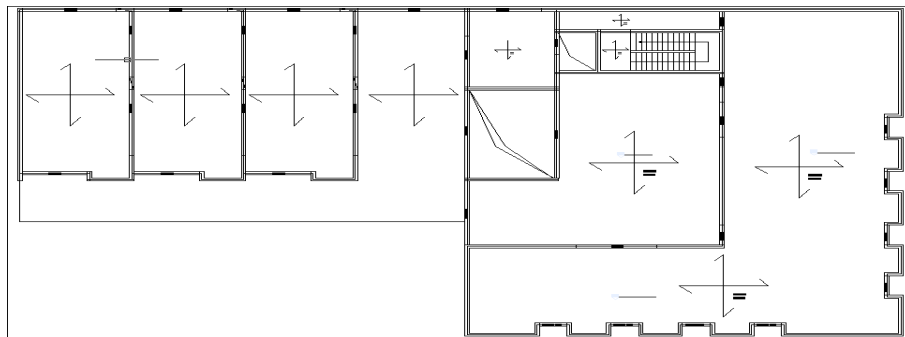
Planta estruturas do piso 1 do módulo C (s/escala)
